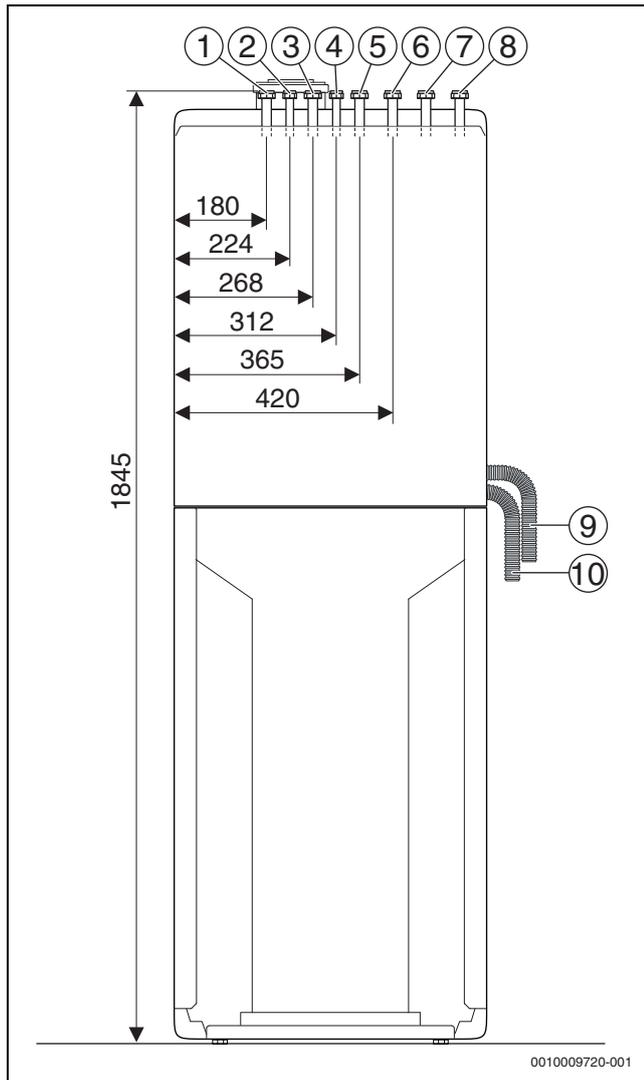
Anschlussmaße des Zubehörs AS-V1/Vertikales Anschluss-Set (Maße in mm)
